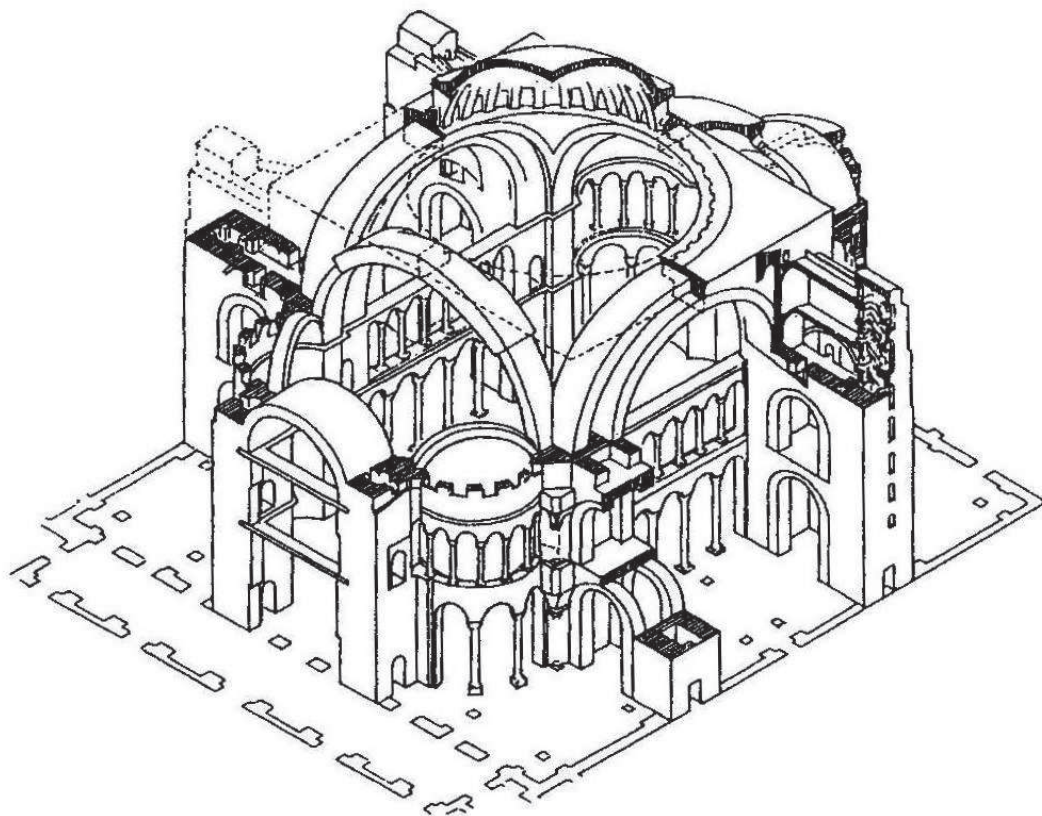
Esquema estructural de Santa Sofía en su concepción original. (Mainstone).
